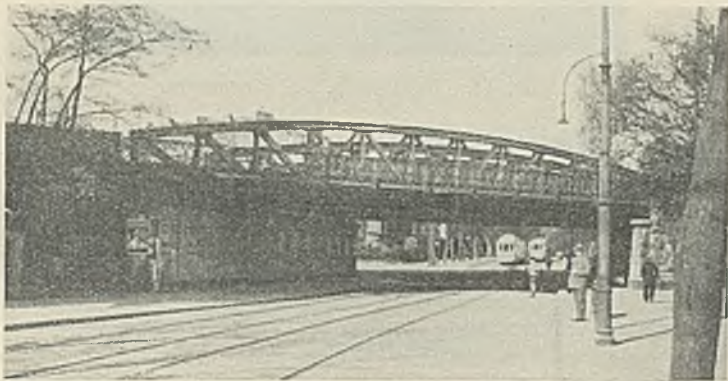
Unterführung der Schwachhauser Heerstraße in Bremen. Alter Überbau.
